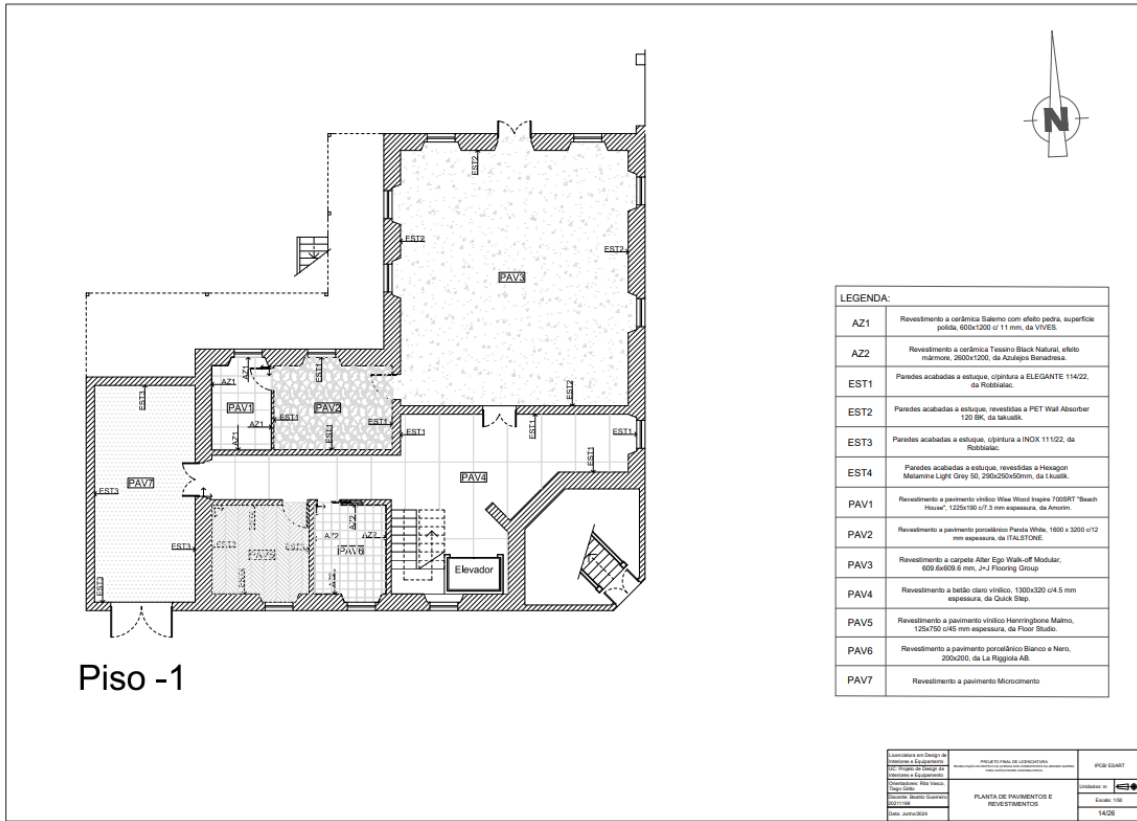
Planta de Pavimentos e Revestimentos, piso -1, sem escala. Fonte: Autor
